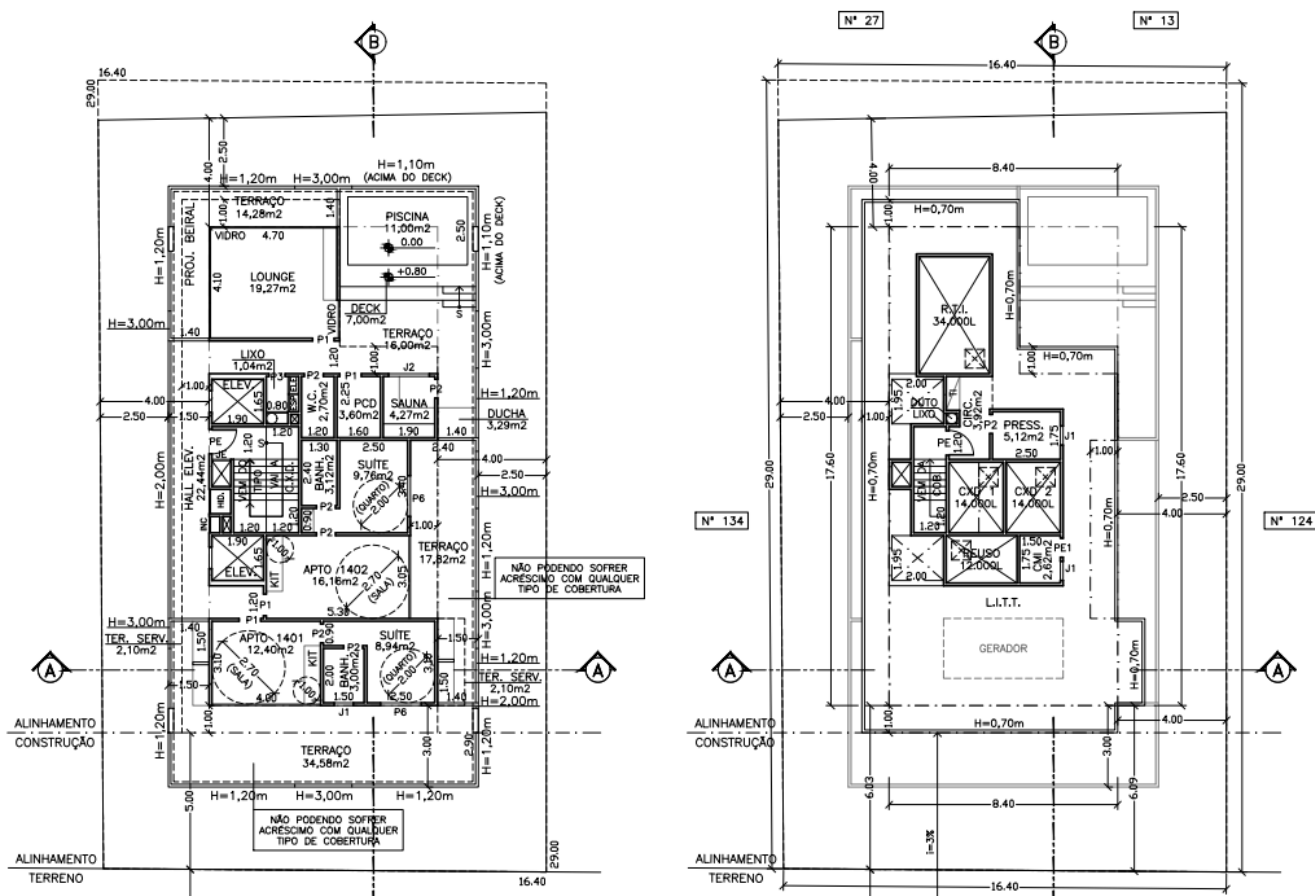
Cobertura e Situação C.X.D – Fonte: Projeto Legal
